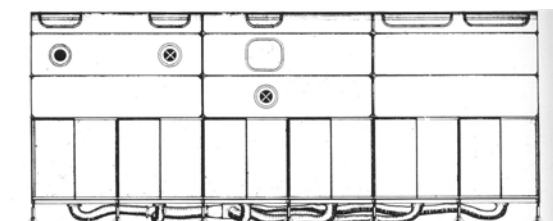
Zip House, Richard Rogers, 1968_ Alçado (Burdett 1996)
